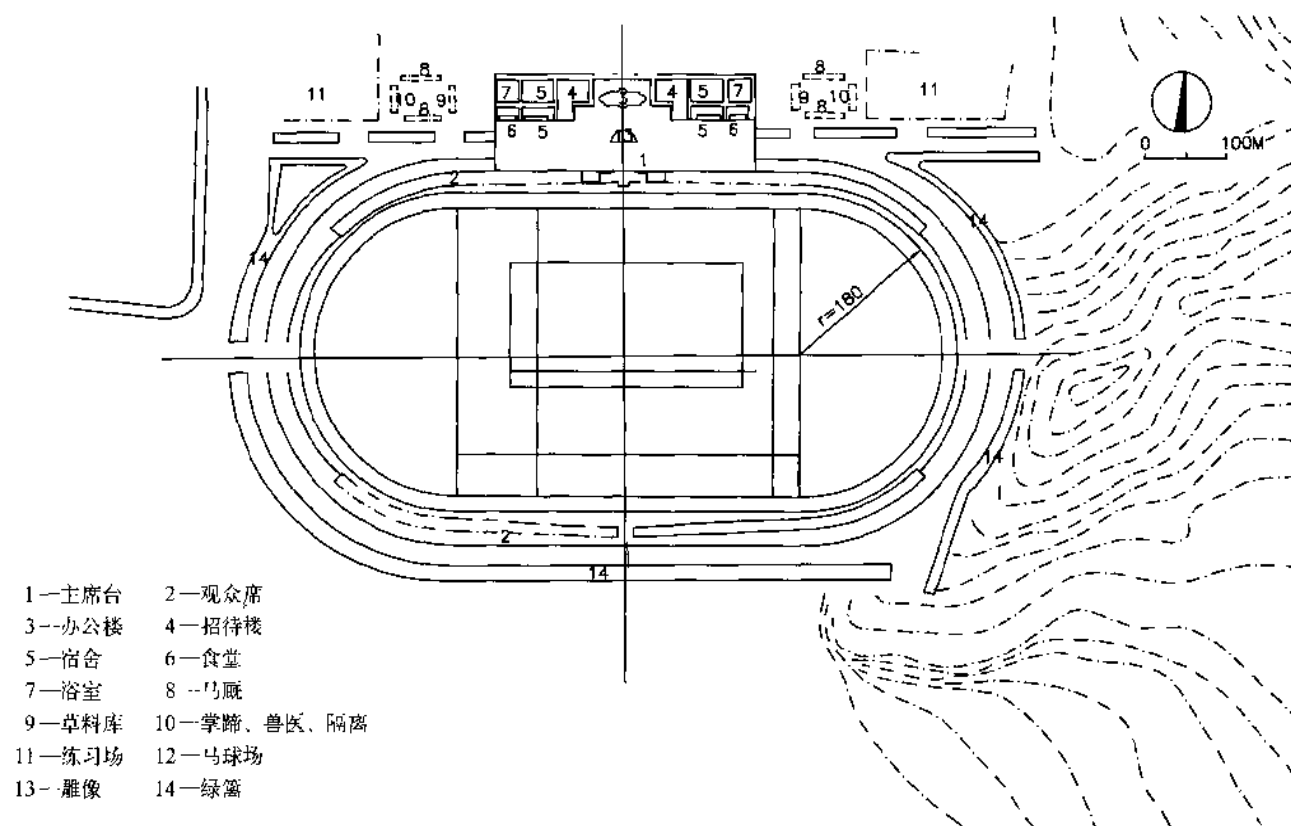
内蒙古呼和浩特赛马中心总平面图
